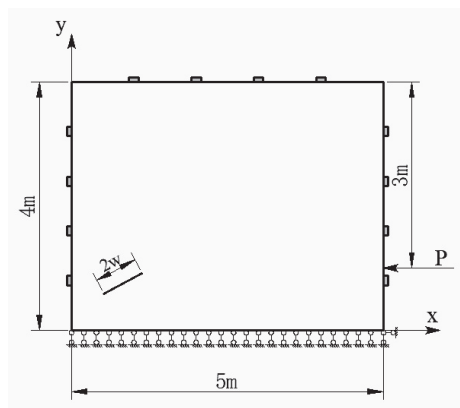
钢筋混凝土板裂缝几何尺寸和位置
